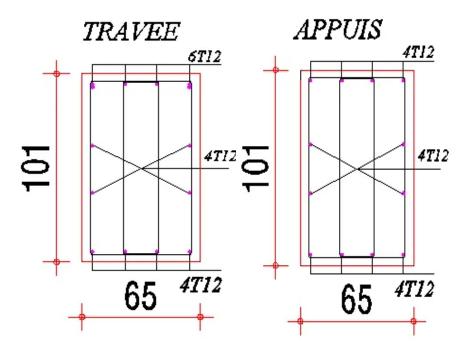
Ferraillage des nervures dans le sens (y-y)
